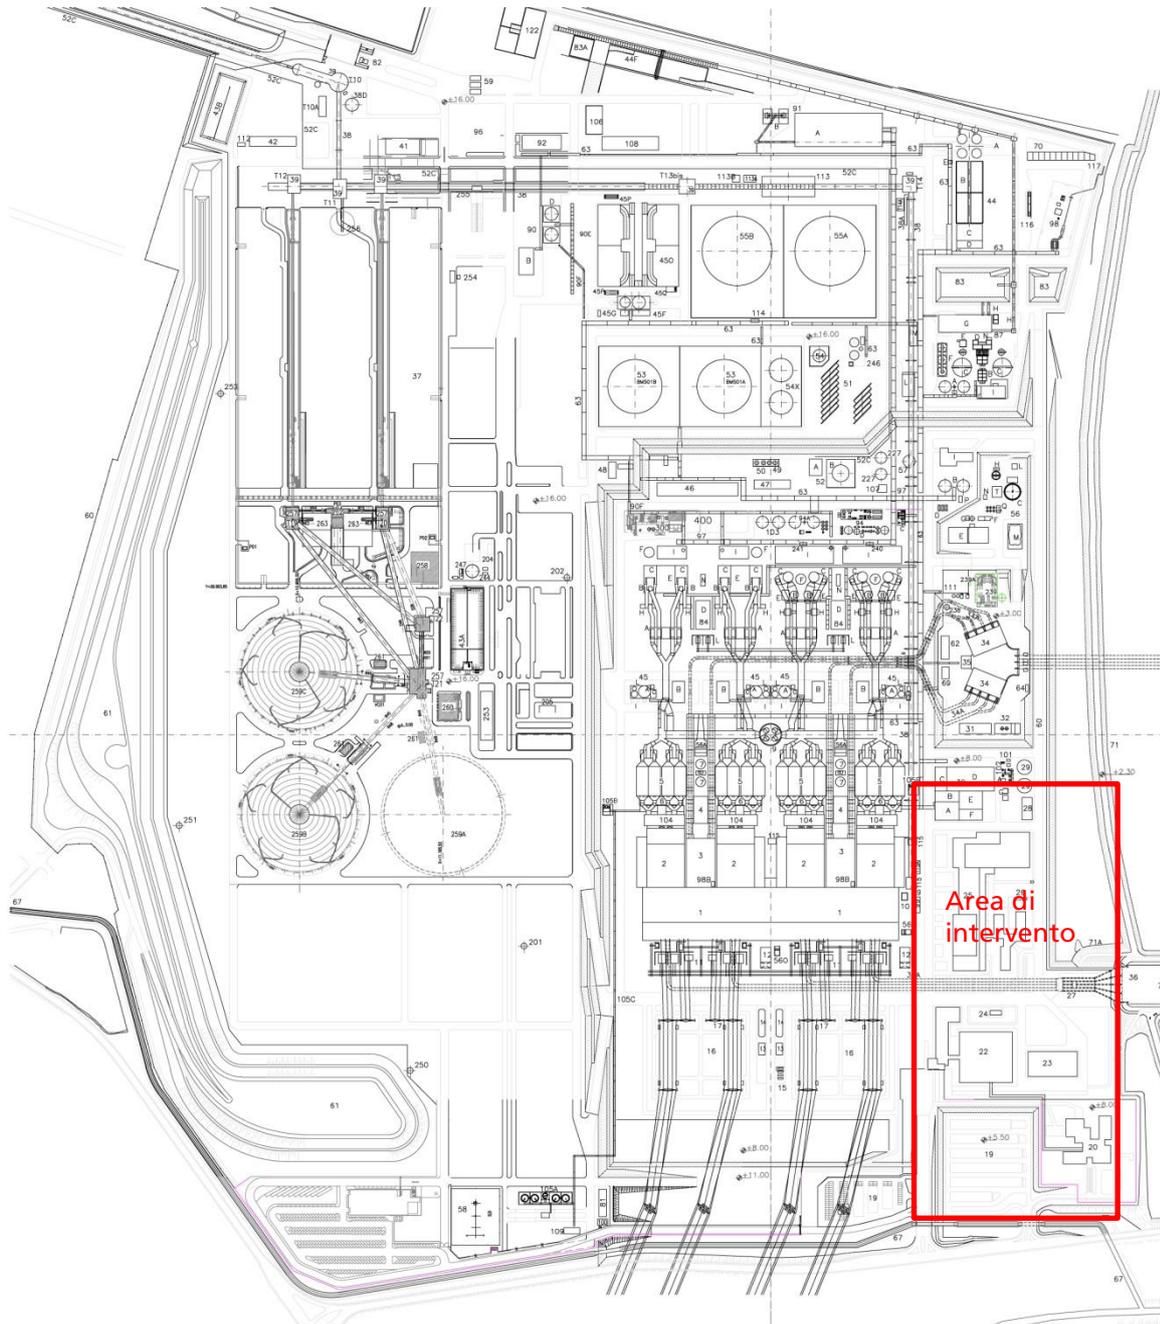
Planimetria generale della centrale nella configurazione attuale, con indicazione dell'area di intervento
